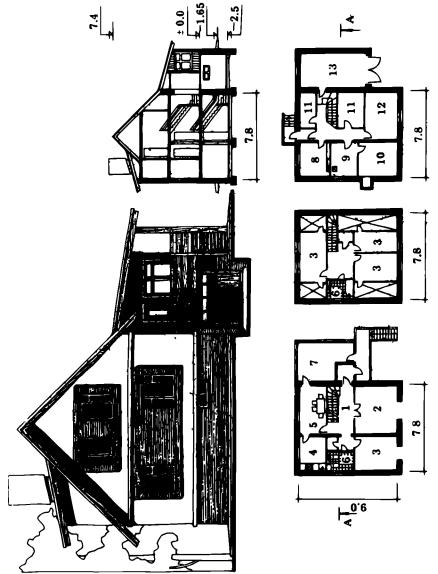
Двухэтажный (жилой) одноквартирный жилой дом из кирпича со второмогательными помещениями в цокольном этаже (Г. п. 144-000-360.85)
